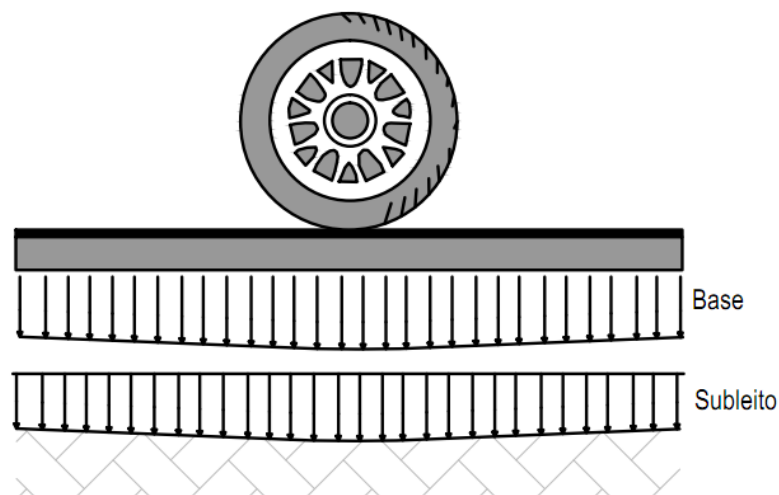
Resposta mecânica de pavimento rígido: pressões distribuídas. (BALBO, 2007)
